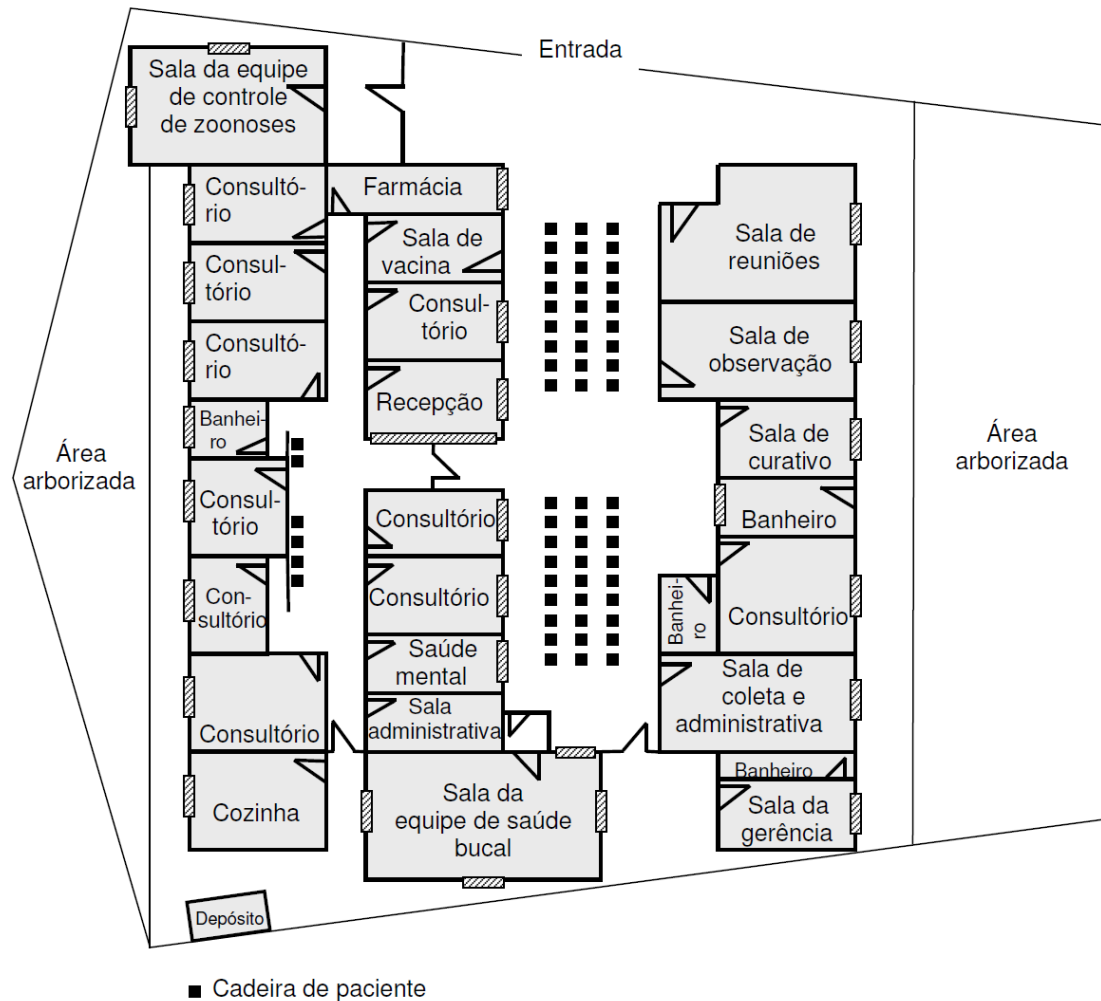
Planta de um Centro de Saúde de Belo Horizonte de construção recente
